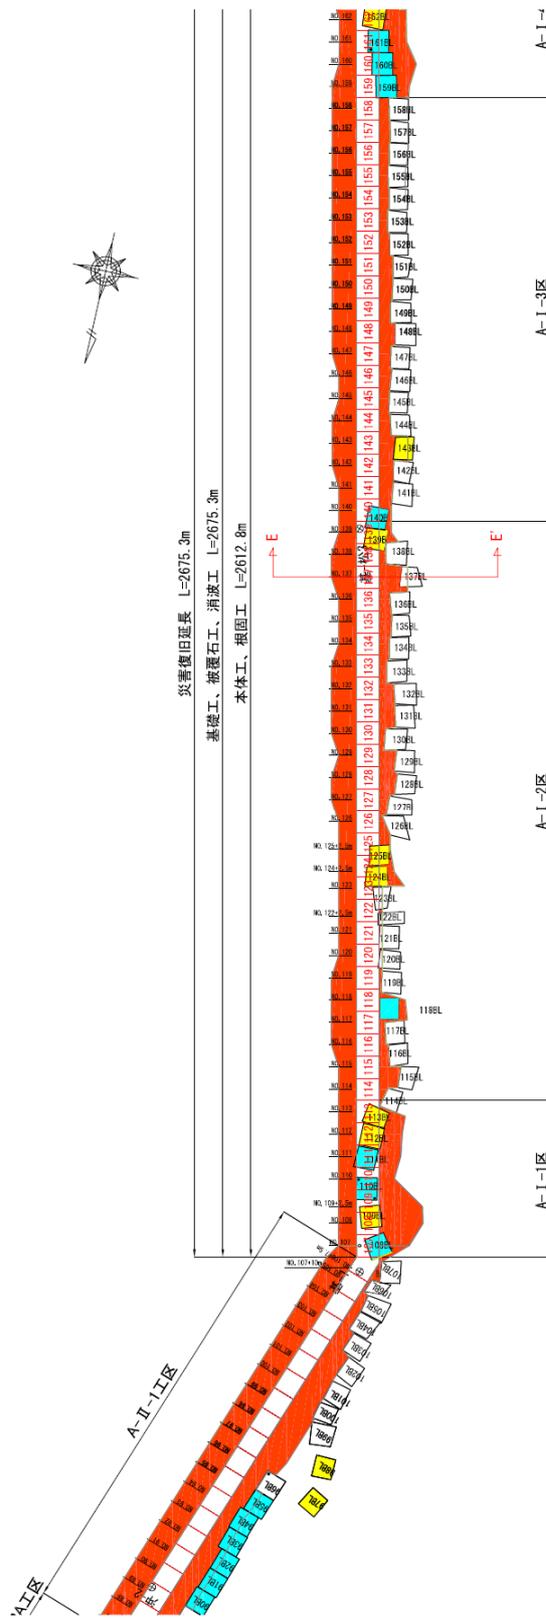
No.1 沖防波堤の平面図 A-I-1区~A-I-3区 (被災後・復旧後)
